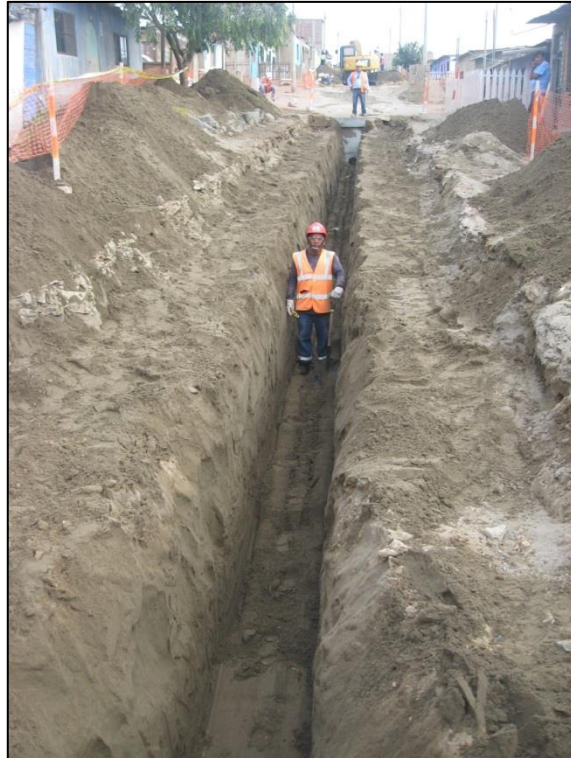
Culminación de excavación tipo I en red de alcantarillado previo a la colocación de tubería (TI.002).
